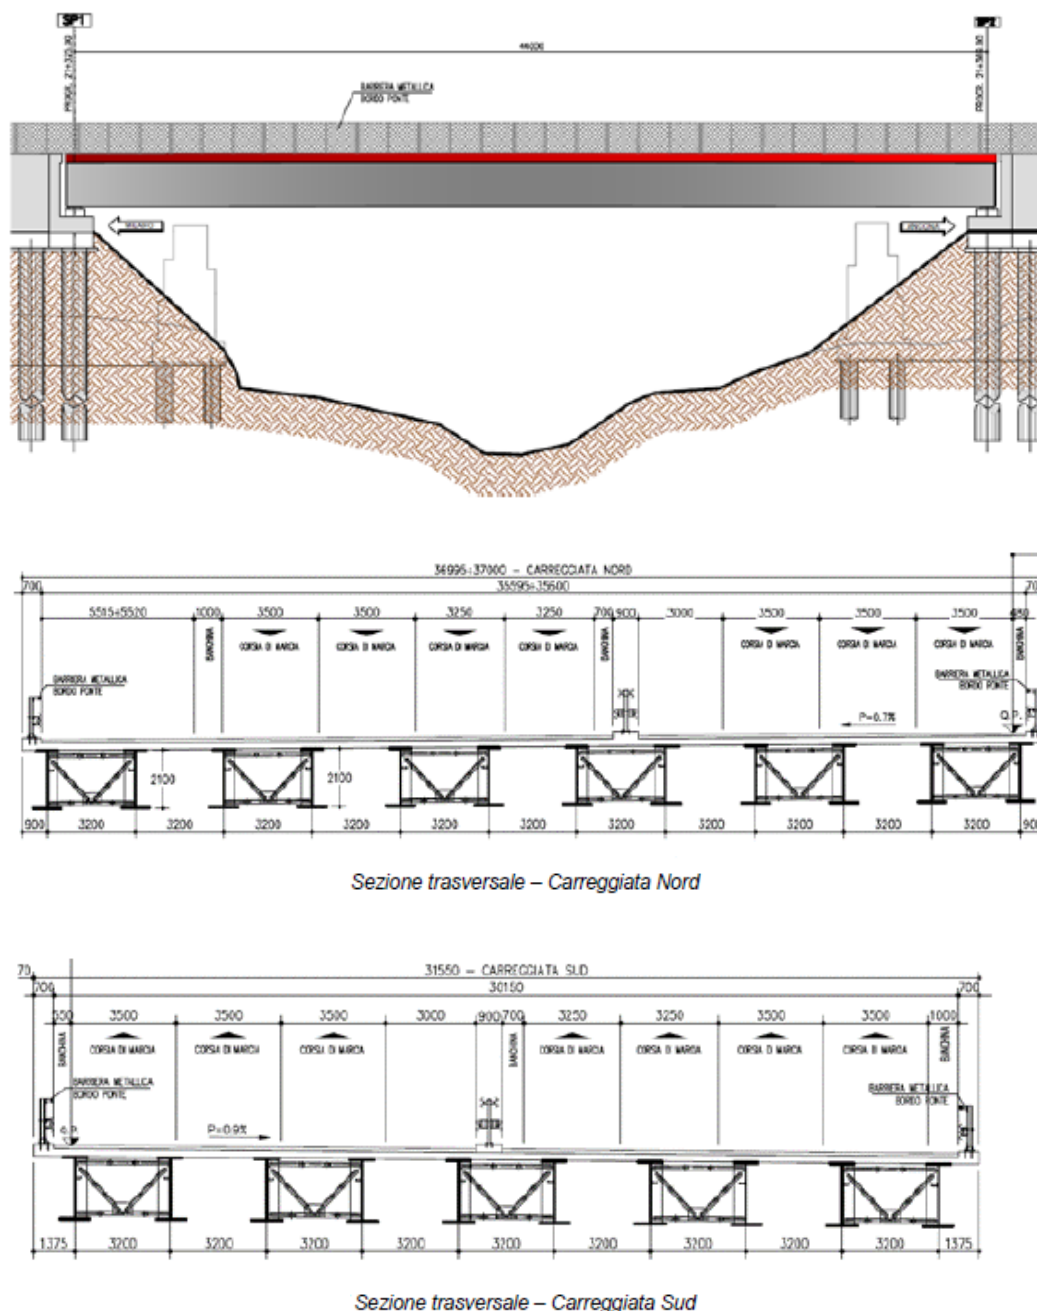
Vista longitudinale e sezioni trasversali del nuovo ponte sul torrente Savena
